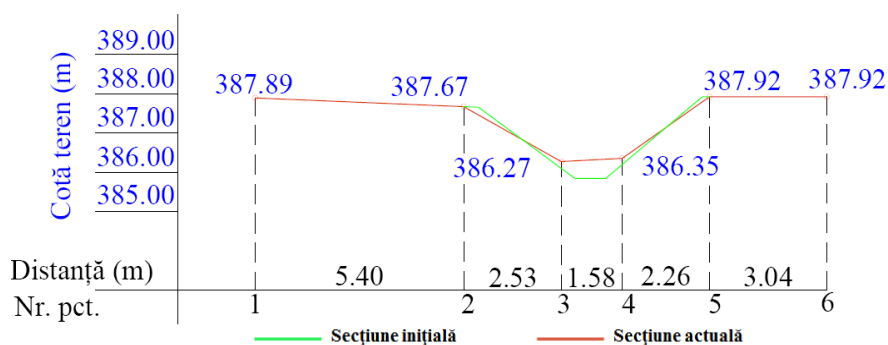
Secțiune transversală printr-un canal colector secundar (original)
